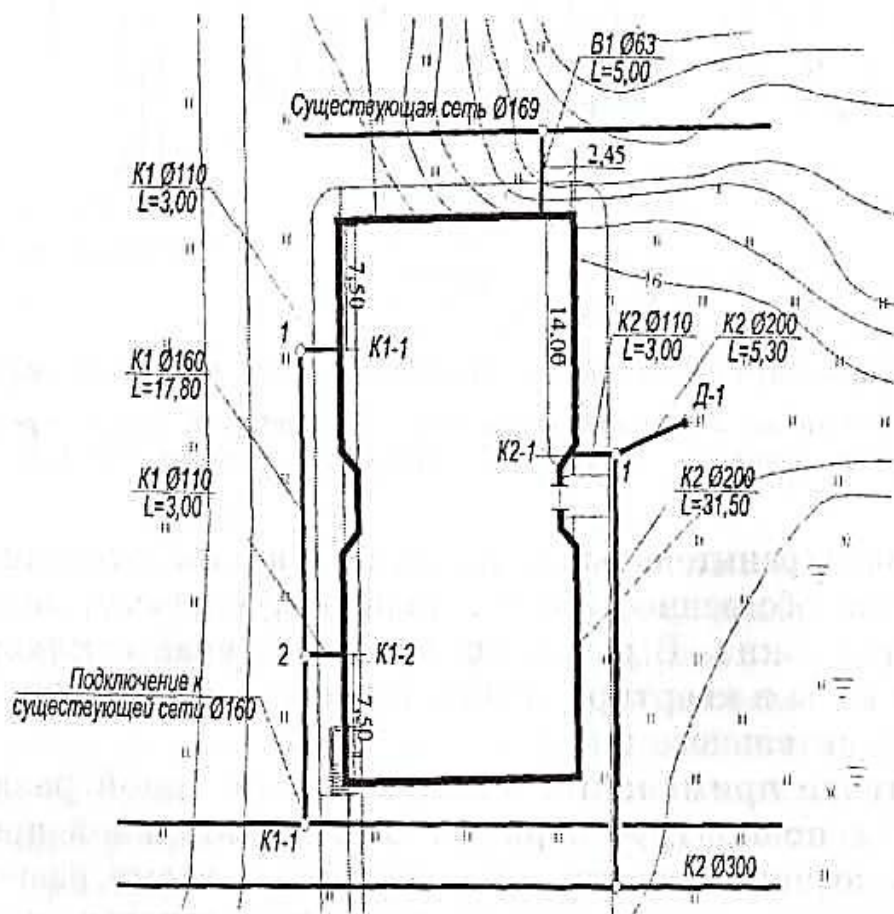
Генеральный план участка с коммуникациями водоснабжения и водоотведения (фрагмент)
